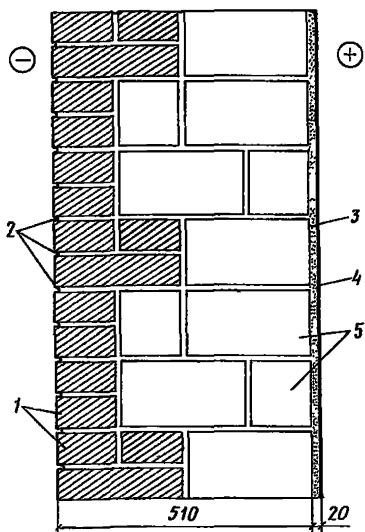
Конструкция наружной стены здания сушки калийного комбината:
